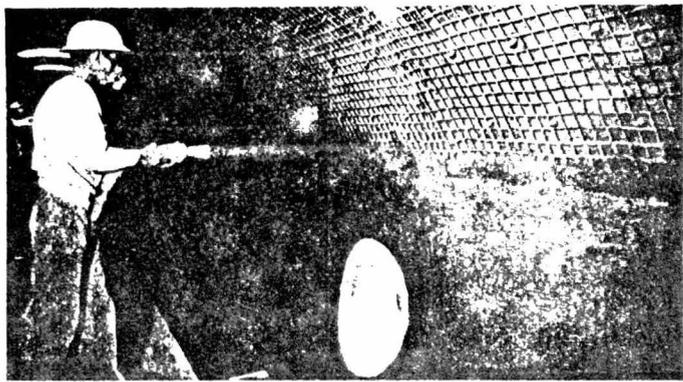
Pulverización de un refractario de hormigón en el interior de un convertidor en una planta de azufre. (Cortesía de Babcock & Wilcox Co.)
